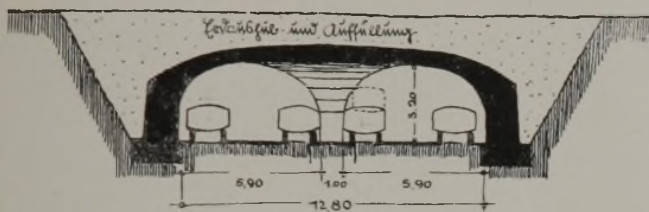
Bruchsteinkeller für Stückfässer mit aufgesattelten Halbstückfässern. Erheblicher Mauerquerschnitt, großer Erdaushub. Bei Lichthöhe von 3,20 m kann gerade noch ein Halbstückfaß aufgesattelt werden.
